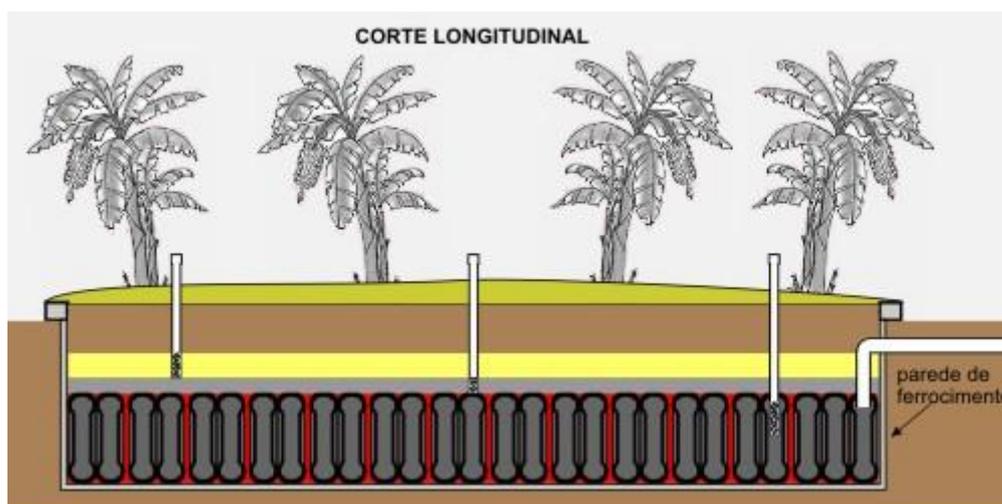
Esquema de Construção do Tanque de Evapotranspiração
